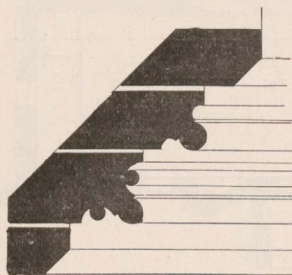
Profil des Westportals der Kirche in Baumgarth 1:20.
